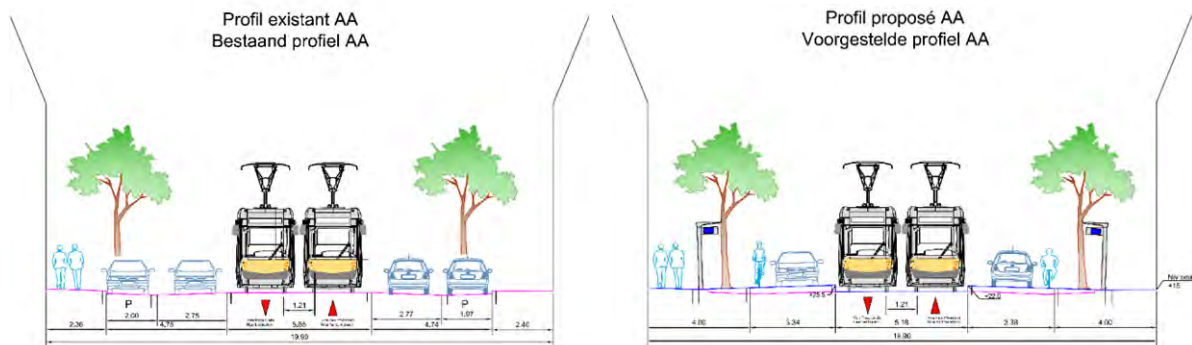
Coupe à travers l'avenue de la Reine en situation existante et projetée à hauteur des nouveaux arrêts Liedts (Bruxelles Mobilité, 2019)
